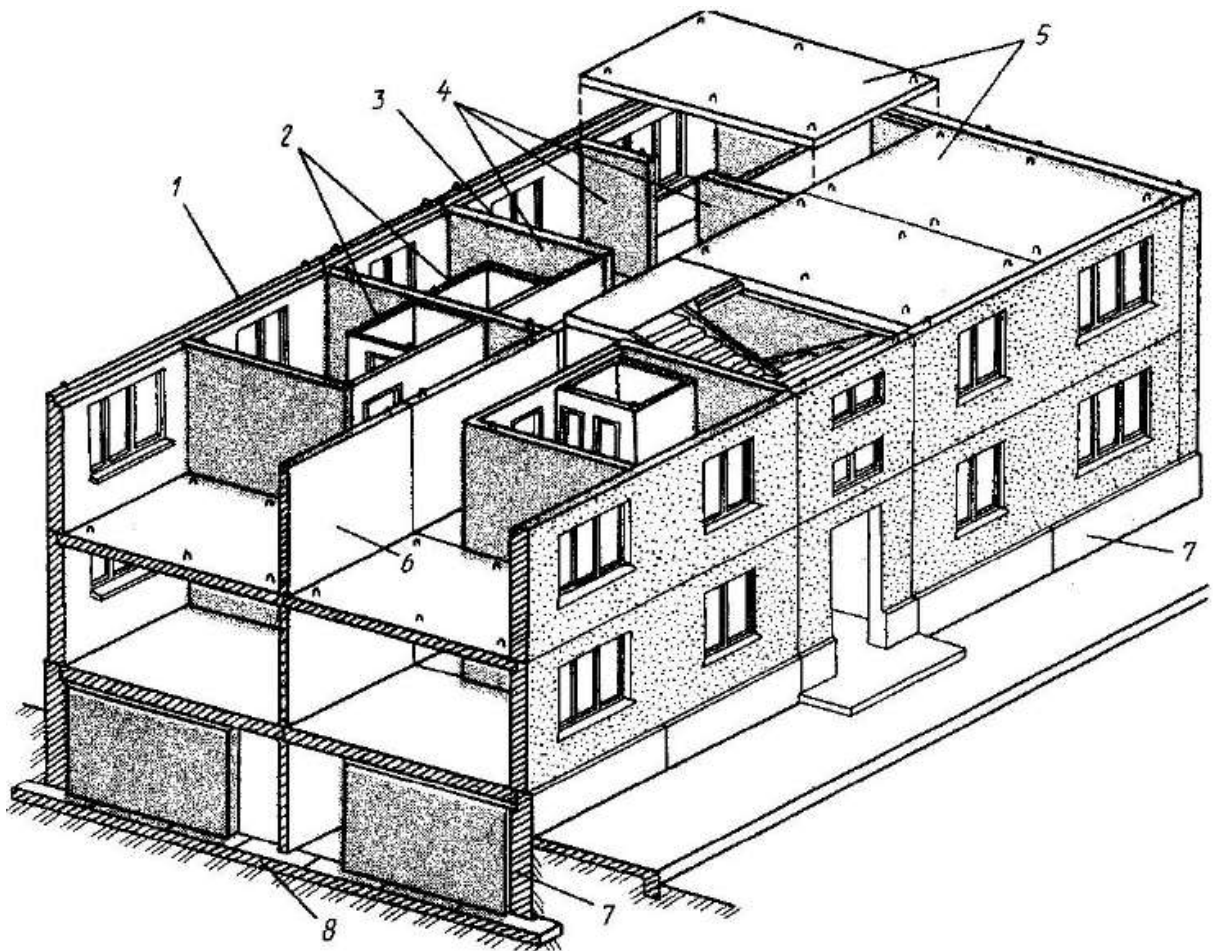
Будівля панельної будівельної системи: 1 – зовнішня стінова панель; 2 – об’ємний блок санітарно-технічної kabіни; 3 – перегородка; 4 – внутрішні панелі поперечних несучих стін; 5 – плити перекриття; 6 – внутрішня панель поздовжньої несучої стіни; 7 – цокольна панель огороження підвалу; 8 – фундаментна плита
